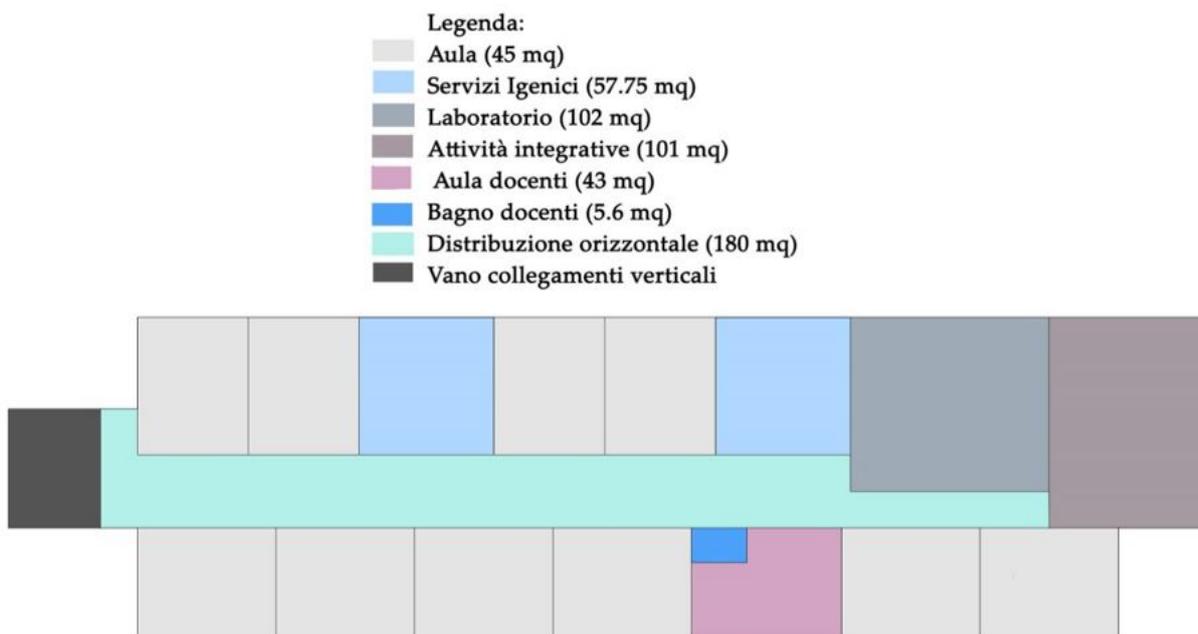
Legenda e planimetria schematica del piano tipo (primaria).
